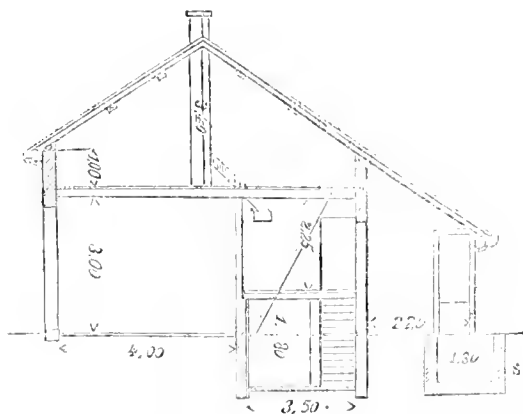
Coupe transversale d'une maison d'ouvriers agricoles.
